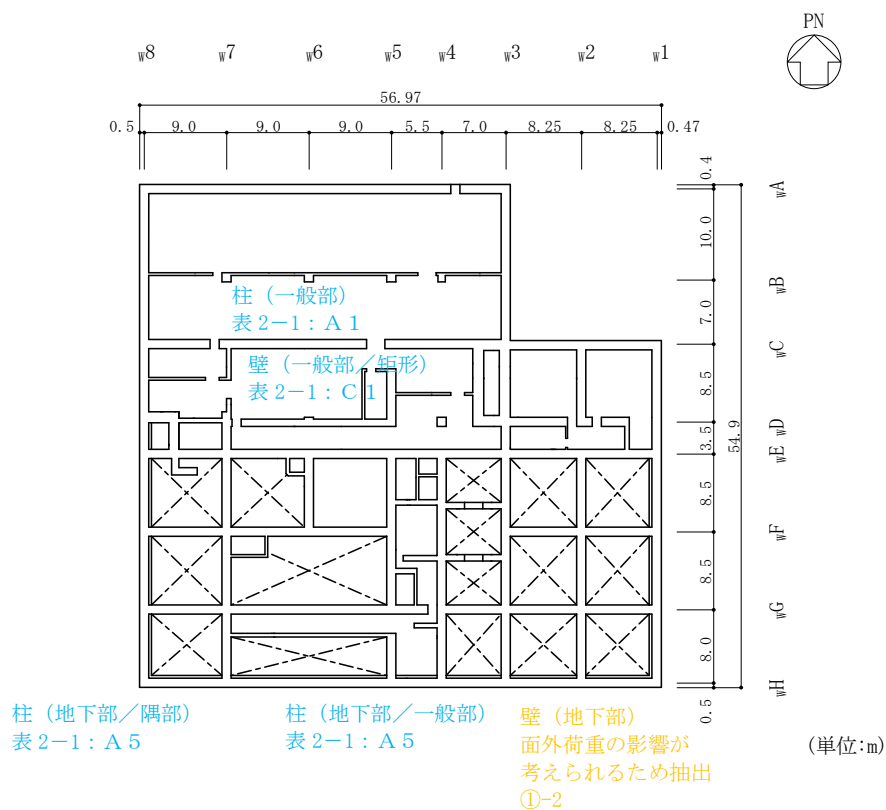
(3) 廃棄物処理建物の概略平面図 (EL 12.3m)
